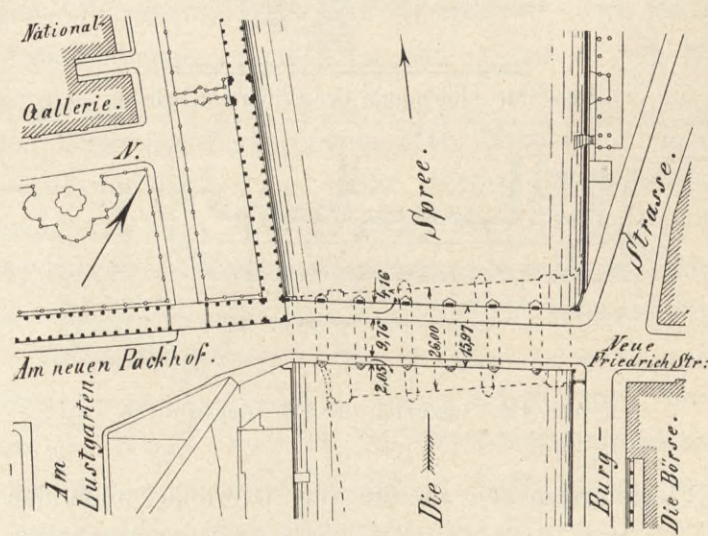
Lageplan der älteren Friedrichs-Brücke.
